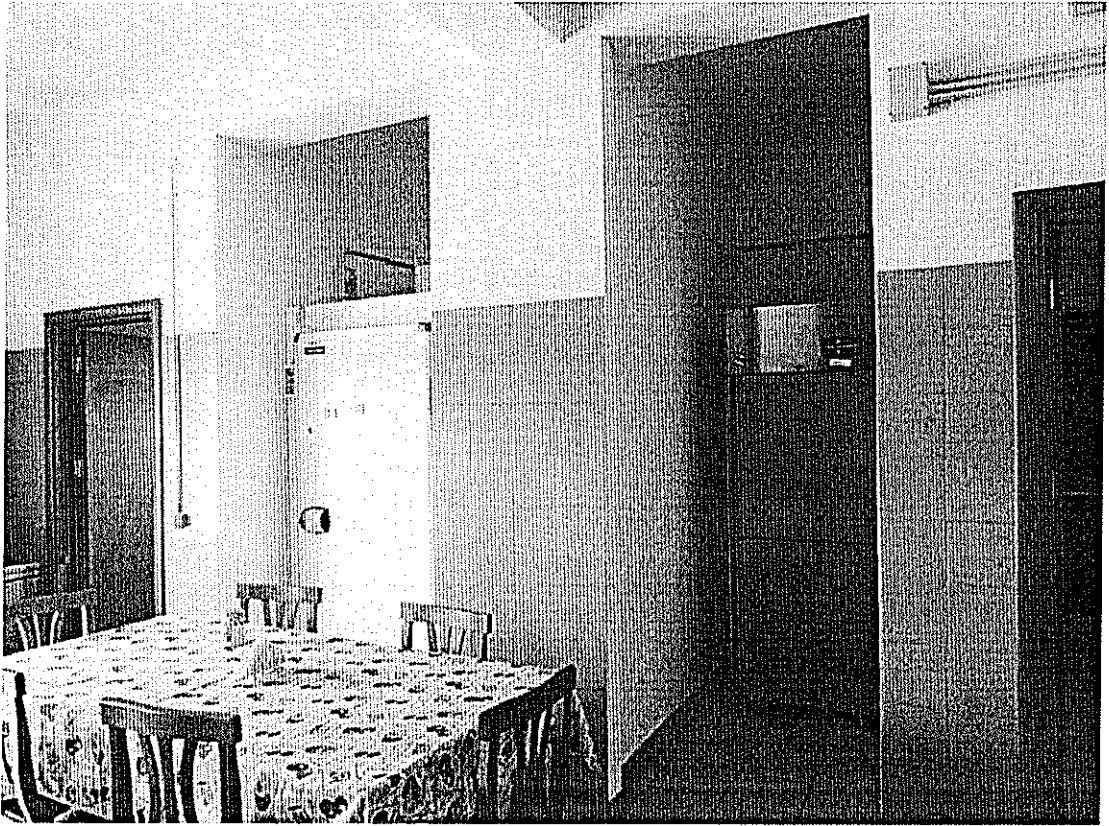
Celle della cucina del primo corpo di fabbrica – piano terra.
